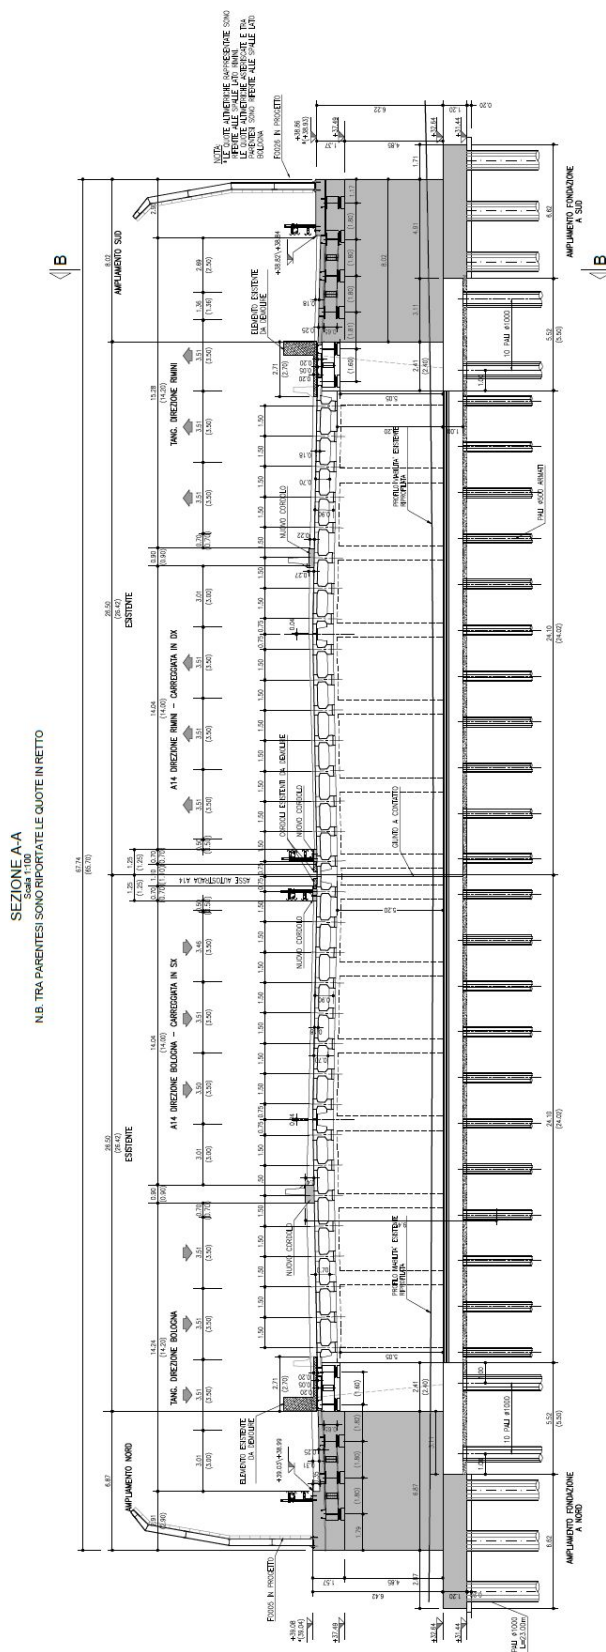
Prospetto longitudinale spalla lato Rimini con ampliamenti
